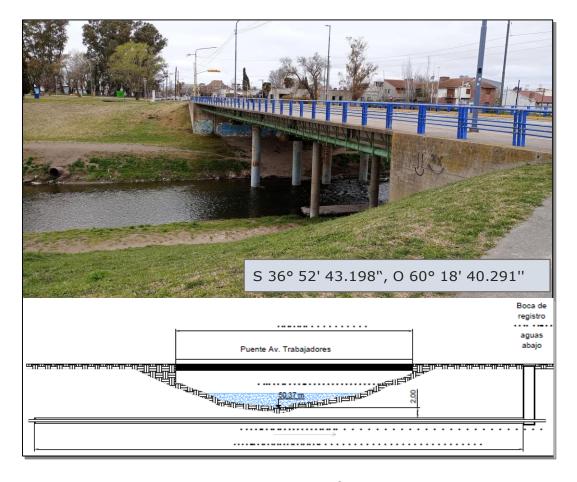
Foto del puente arroyo Tapalqué calle De los Trabajadores.
